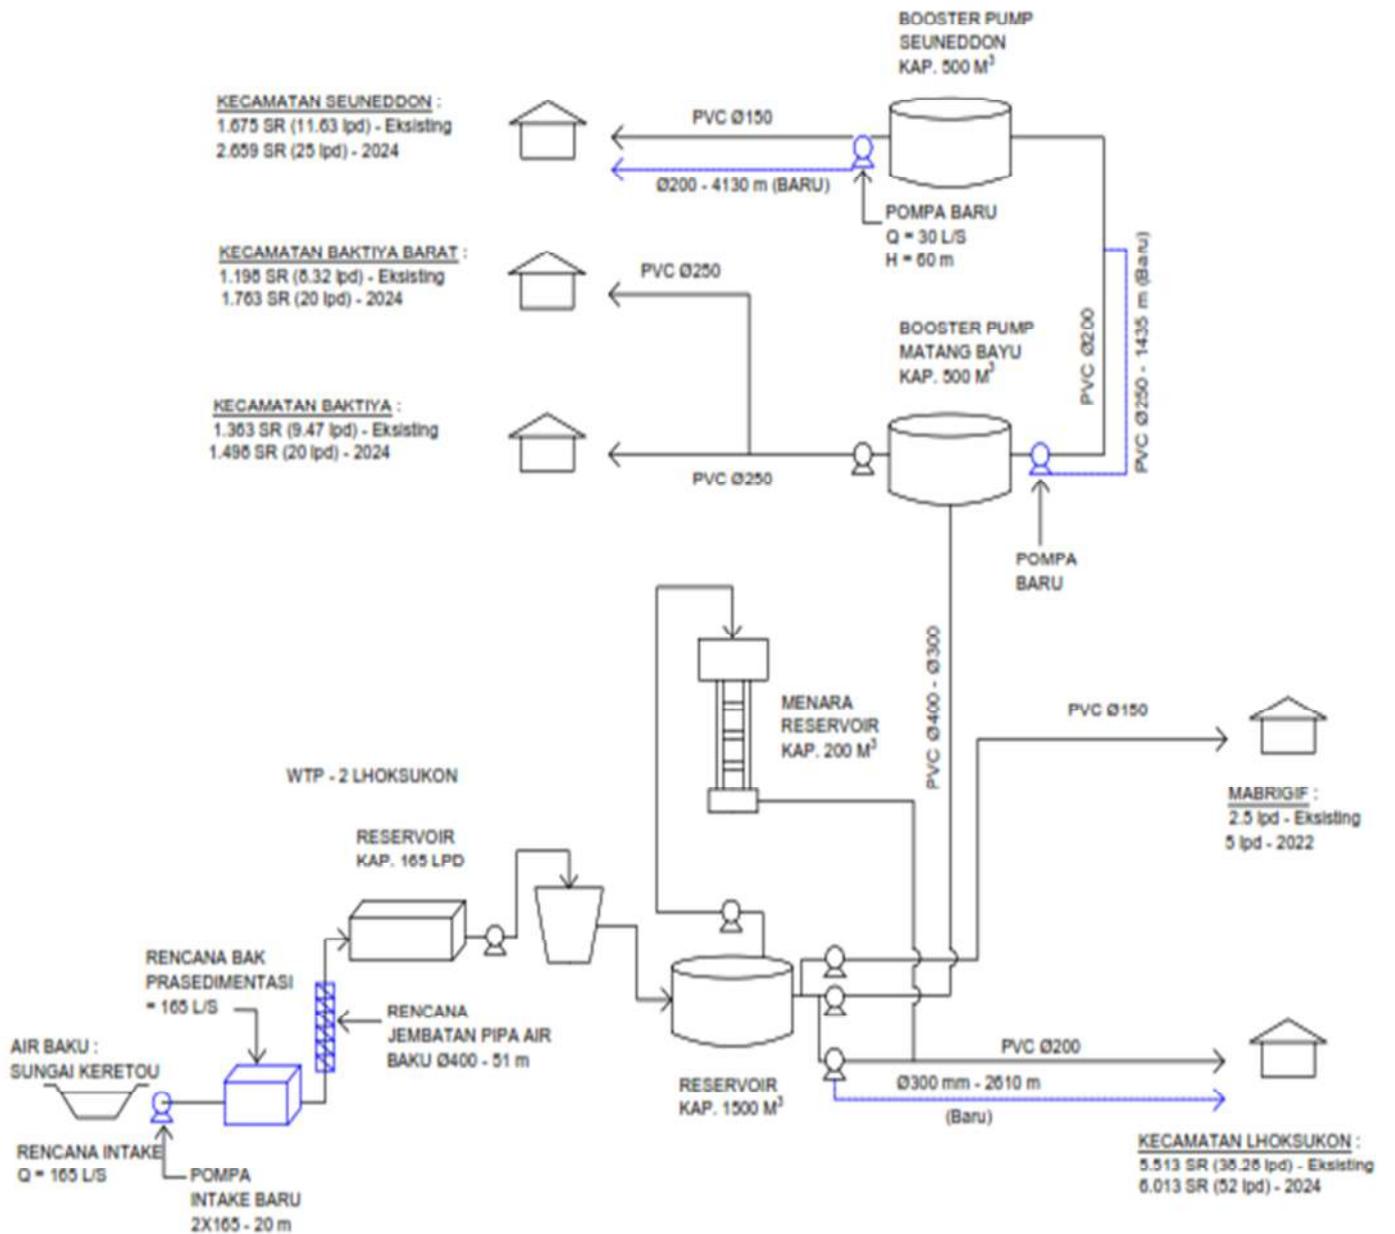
Skematik Jaringan Pipa Eksisting
